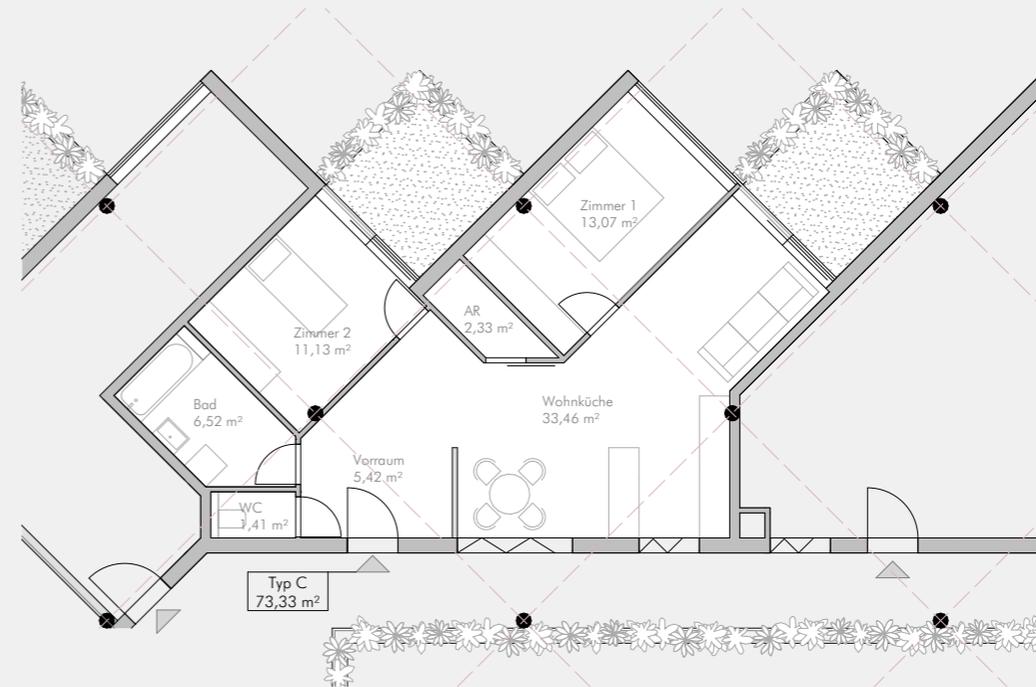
| Grundriss einer Wohnung des Typs C im Maßstab 1:150
